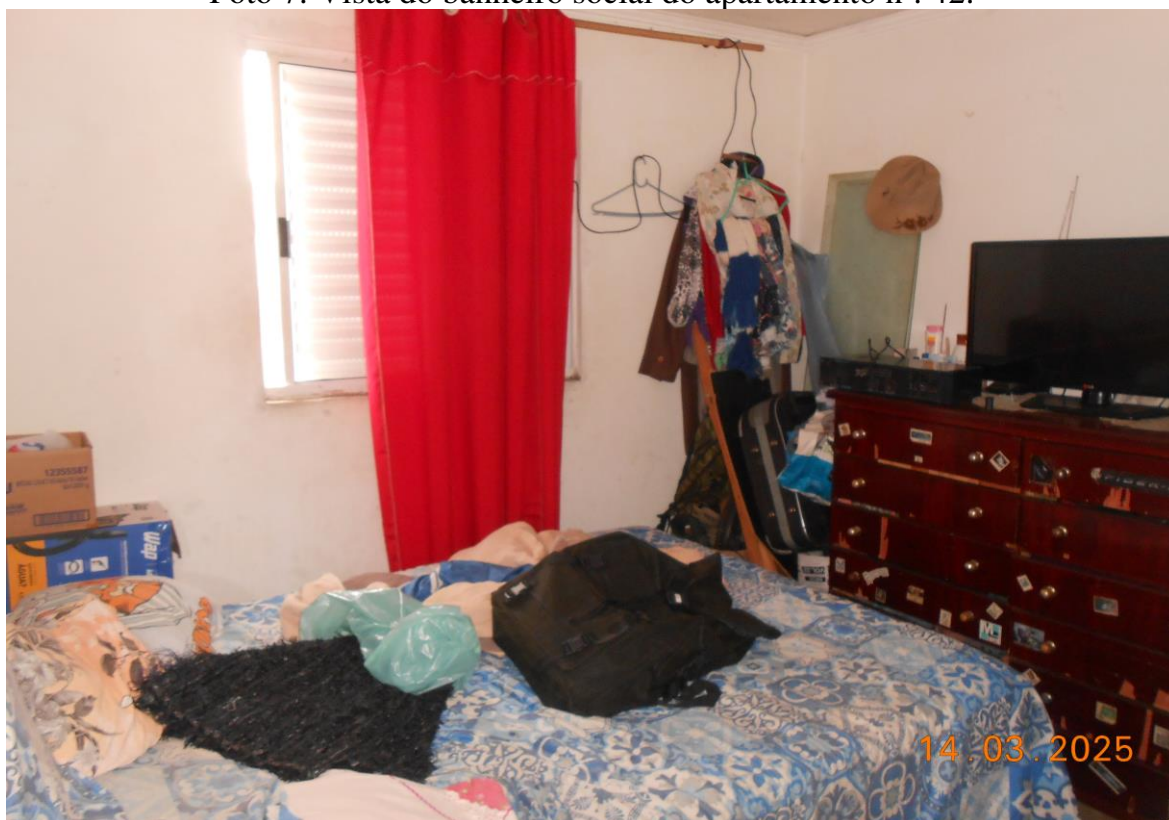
Vista de um dos dormitórios do apartamento nº. 42.
